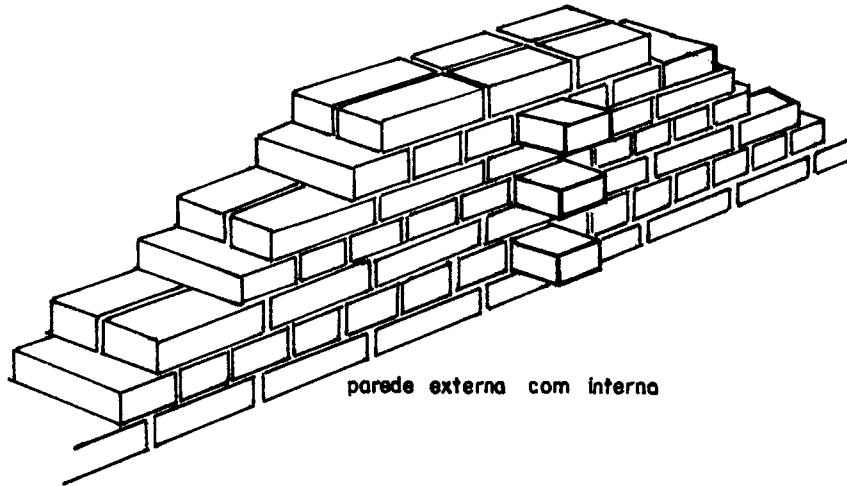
Canto em parede externa de um tijolo com parede interna de meio tijolo no ajuste francês
